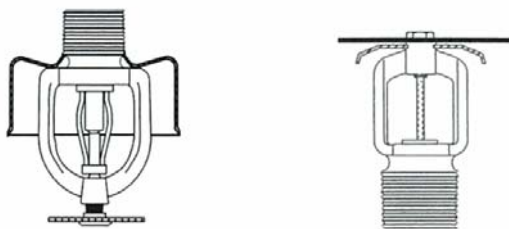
Sprinklers com elemento termo-sensível protegido (pendente e vertical)
